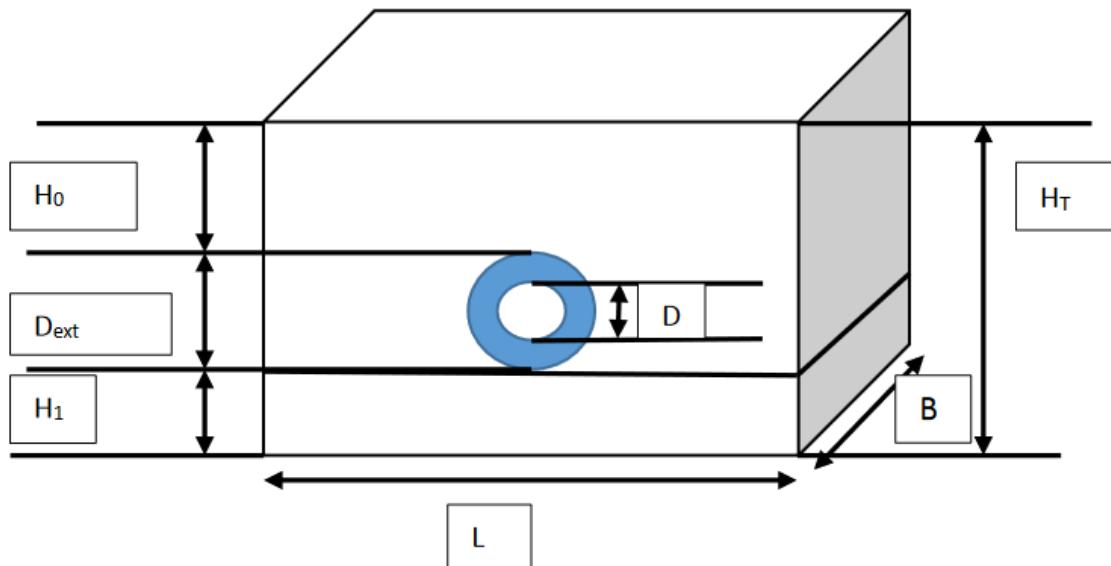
coupe de perspective d'une fouille avec conduite
